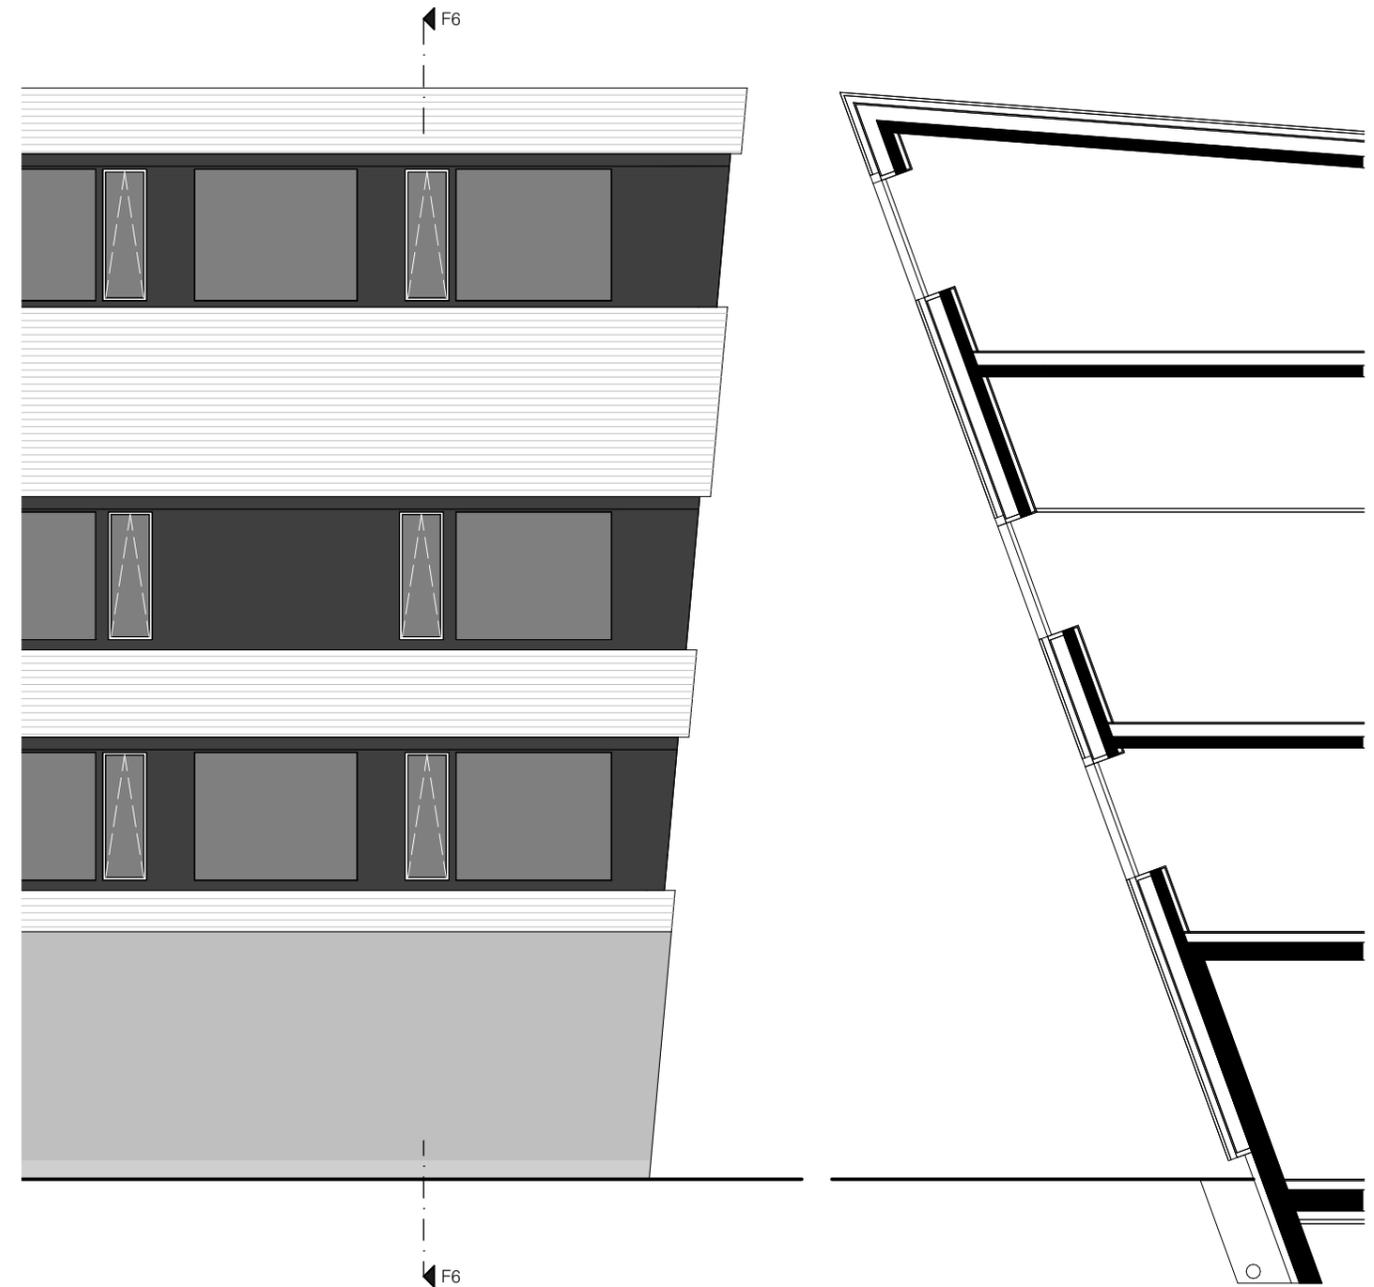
Übersicht Fassadenschnitt Vitalhalle 1:100
